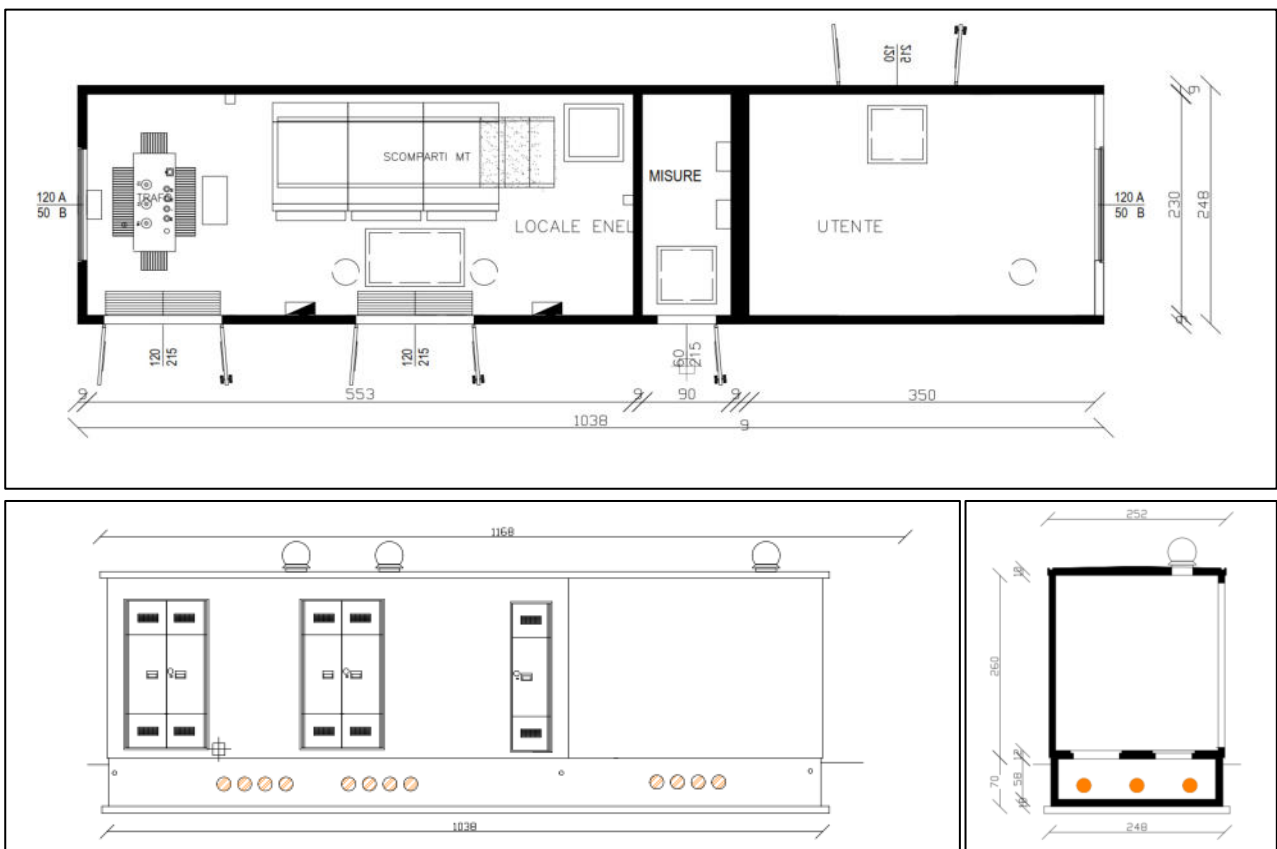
Vista in pianta/prospetto/sezione cabina di consegna.
